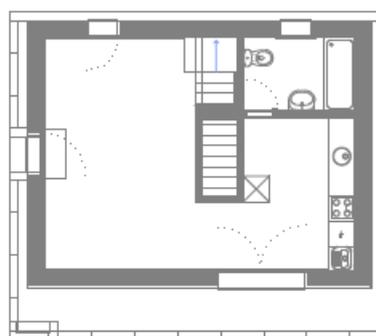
Planta do piso 0 de uma habitação T1 reabilitada (escala 1:200)
